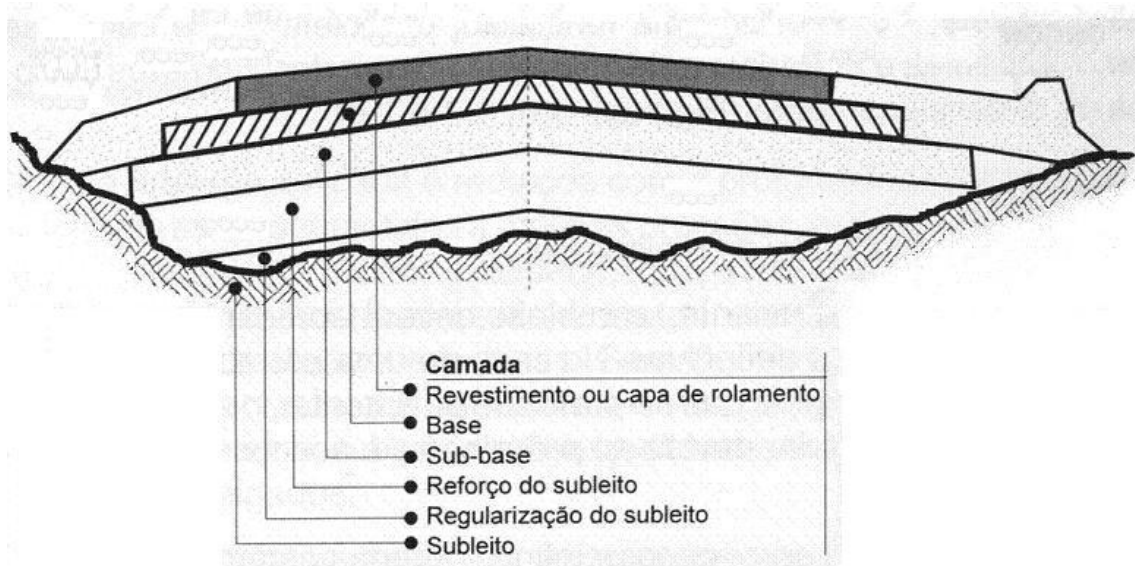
Seção transversal típica de um pavimento (SENÇO, 1997)
